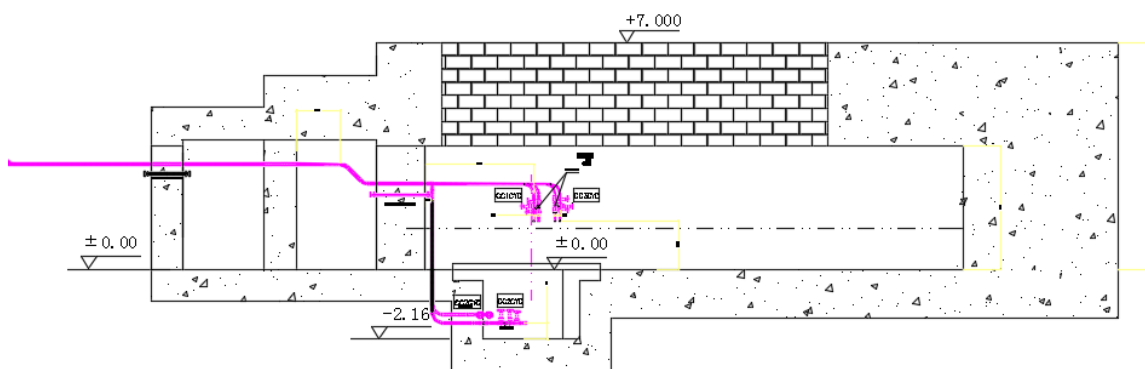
冷却水管线穿越屏蔽墙体示意图（垂直布置图）
